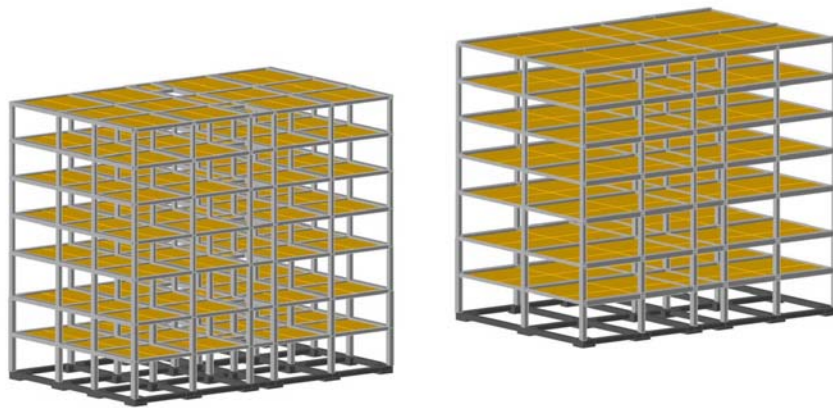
Estructura con forjados hormigón armado in situ frente a estructura con forjados de placas alveolares [12]
